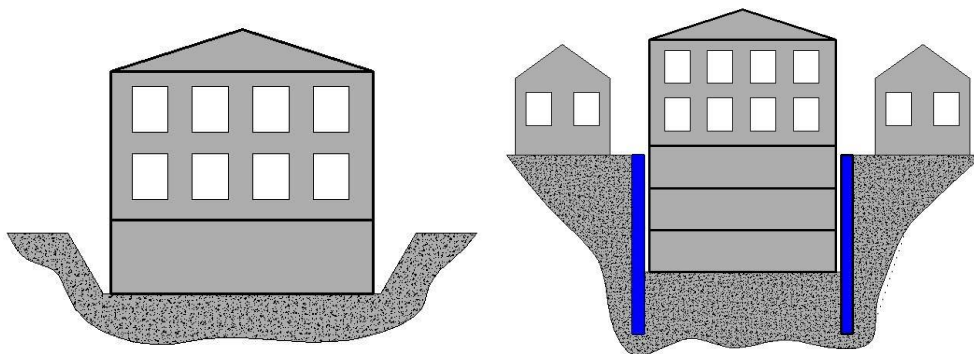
Конструкції, що споруджені способом «стіна в ґрунті»:
